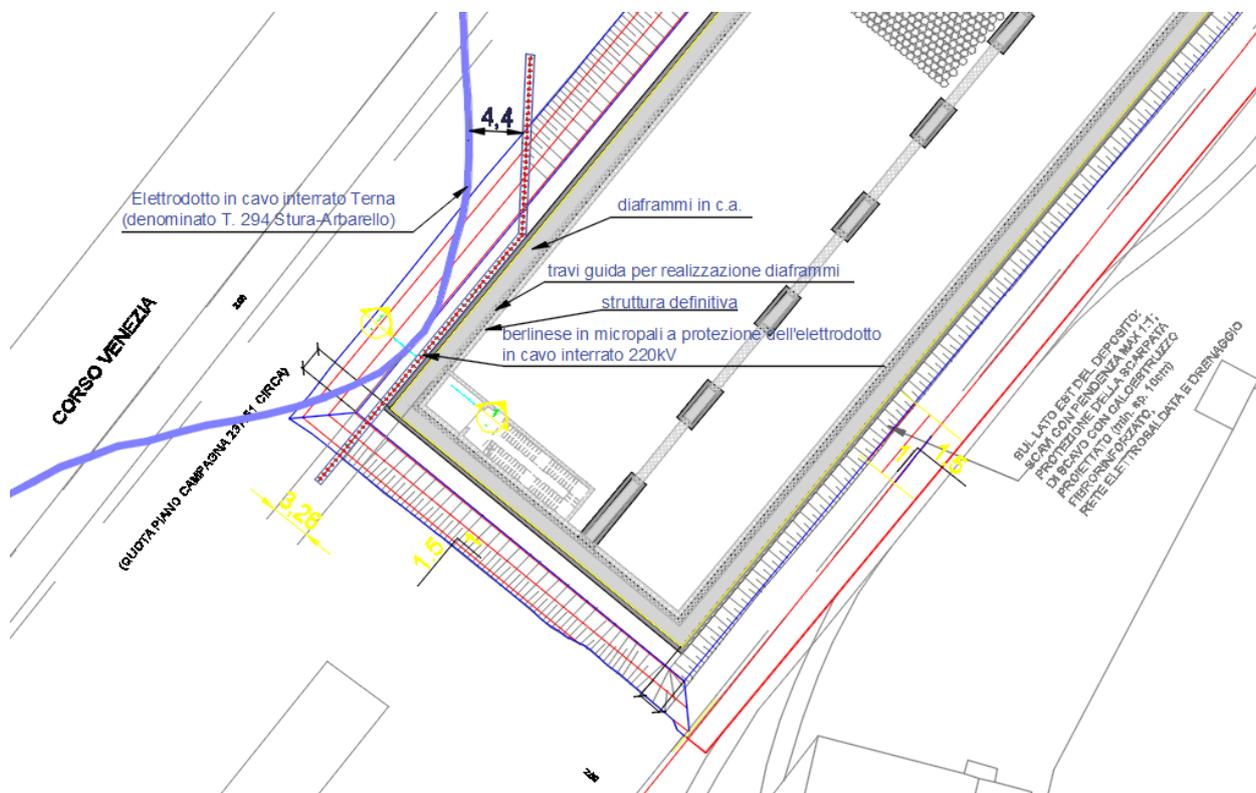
Stralcio planimetrico della pianta scavi con ubicazione della berlinese di micropali a protezione dell'Elettrodotto in cavo interrato di Terna.
